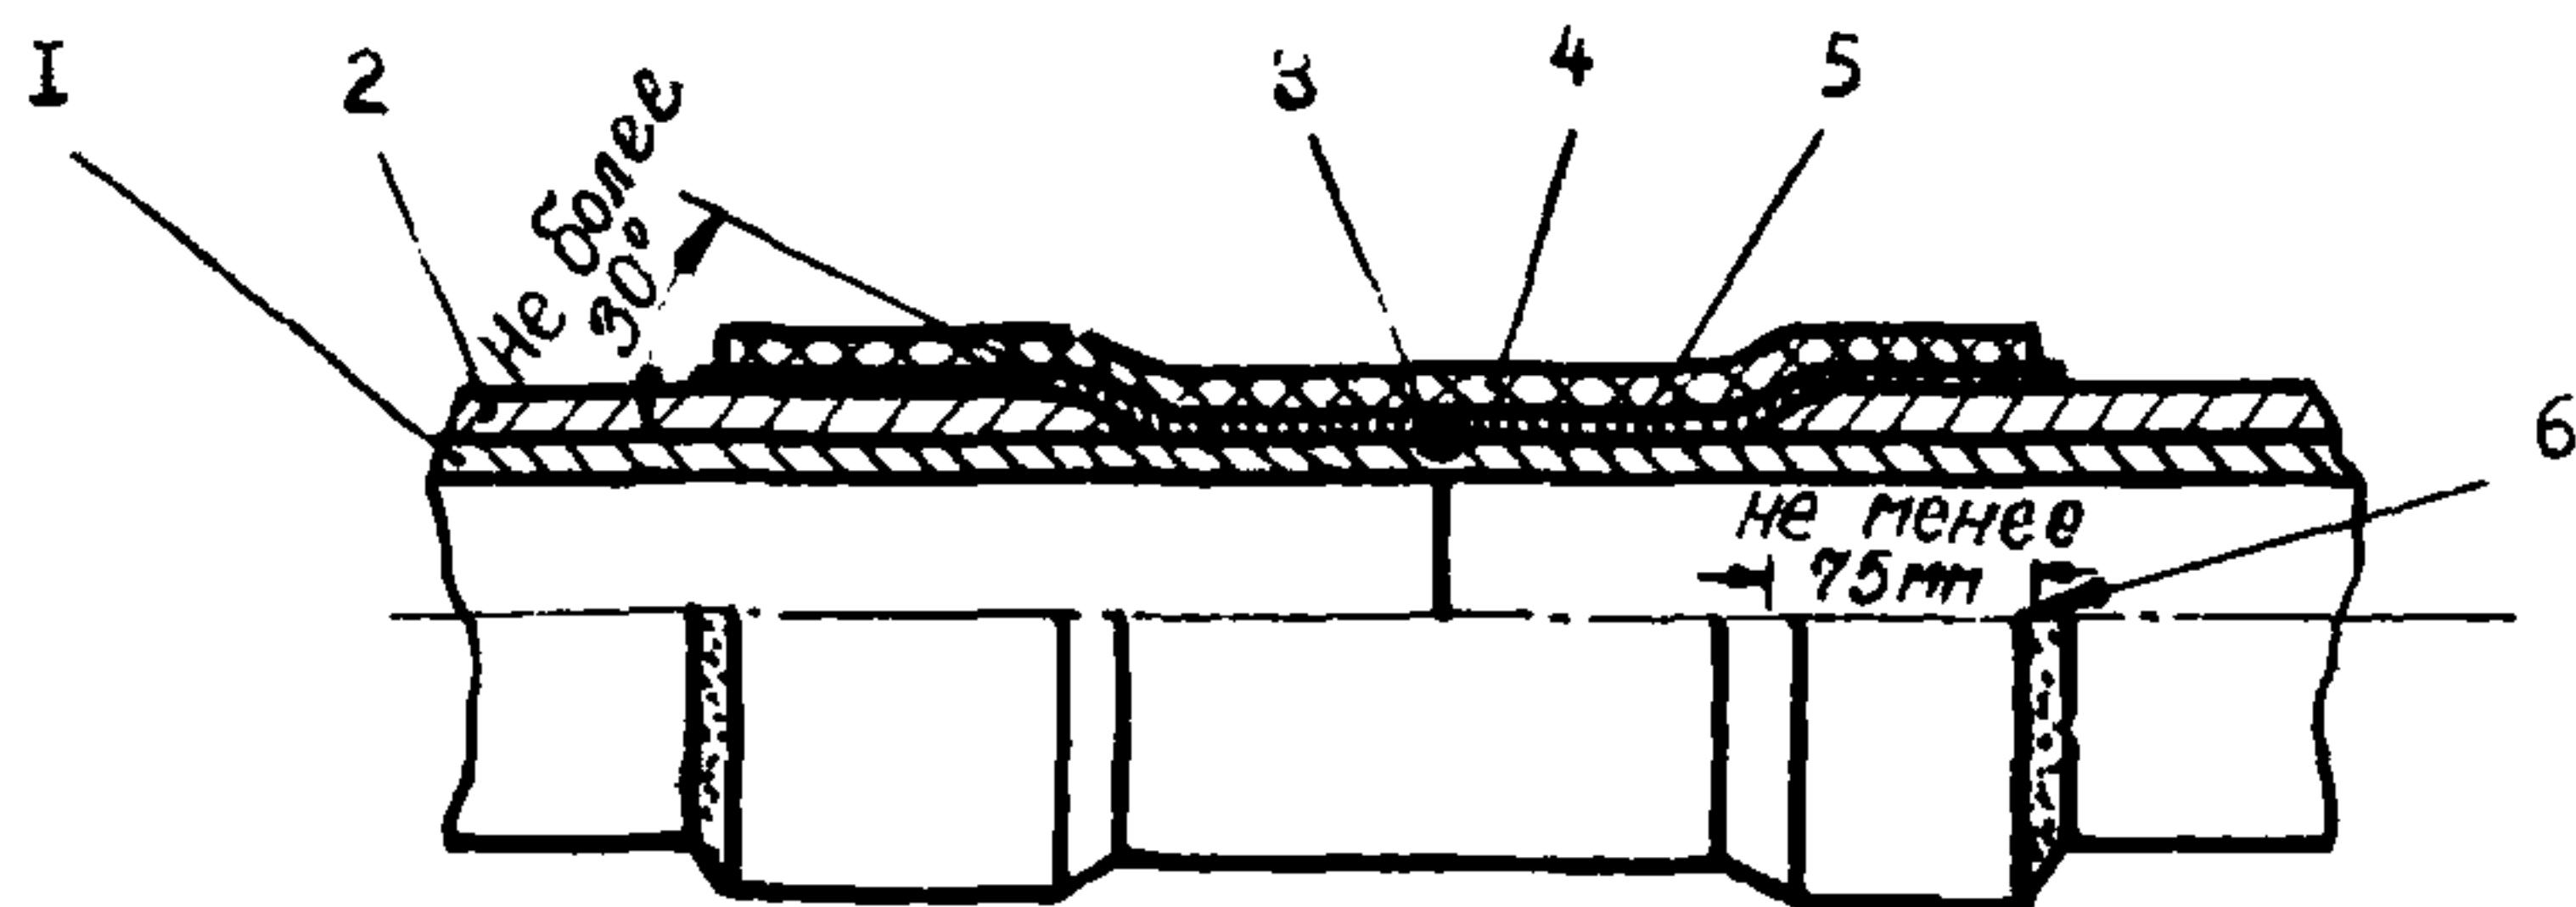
Конструкция изоляции зоны сварного стыка из термоусадочной муфты:
